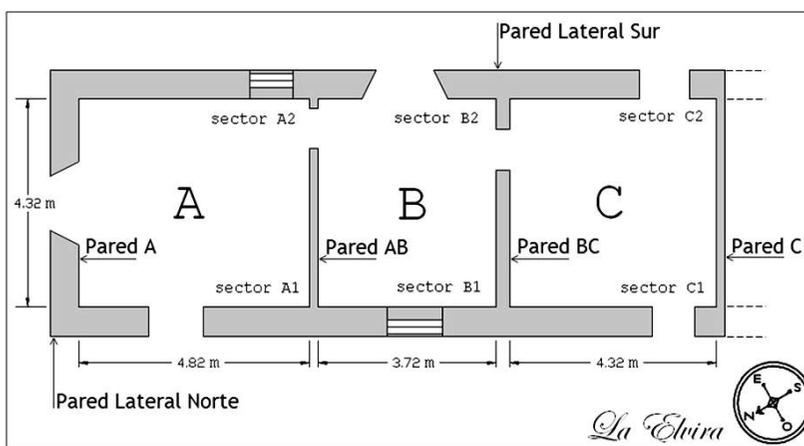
Plano general, con el detalle de la denominación de cada sector relevado
